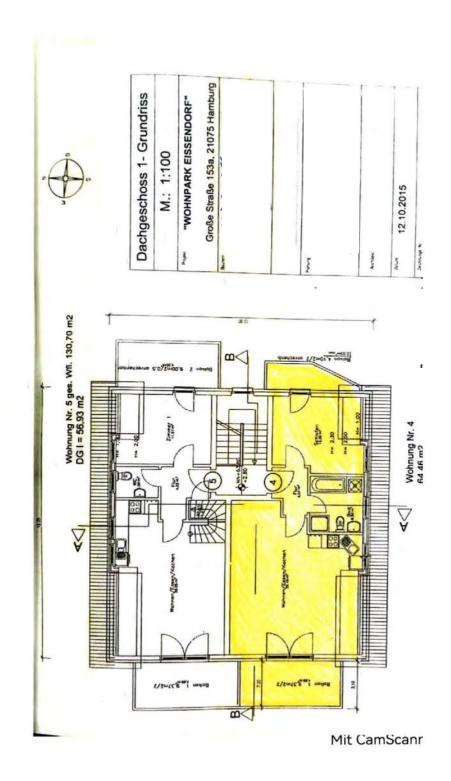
Grundriss Whg. Nr. 4 gemäß Kaufvertrag
